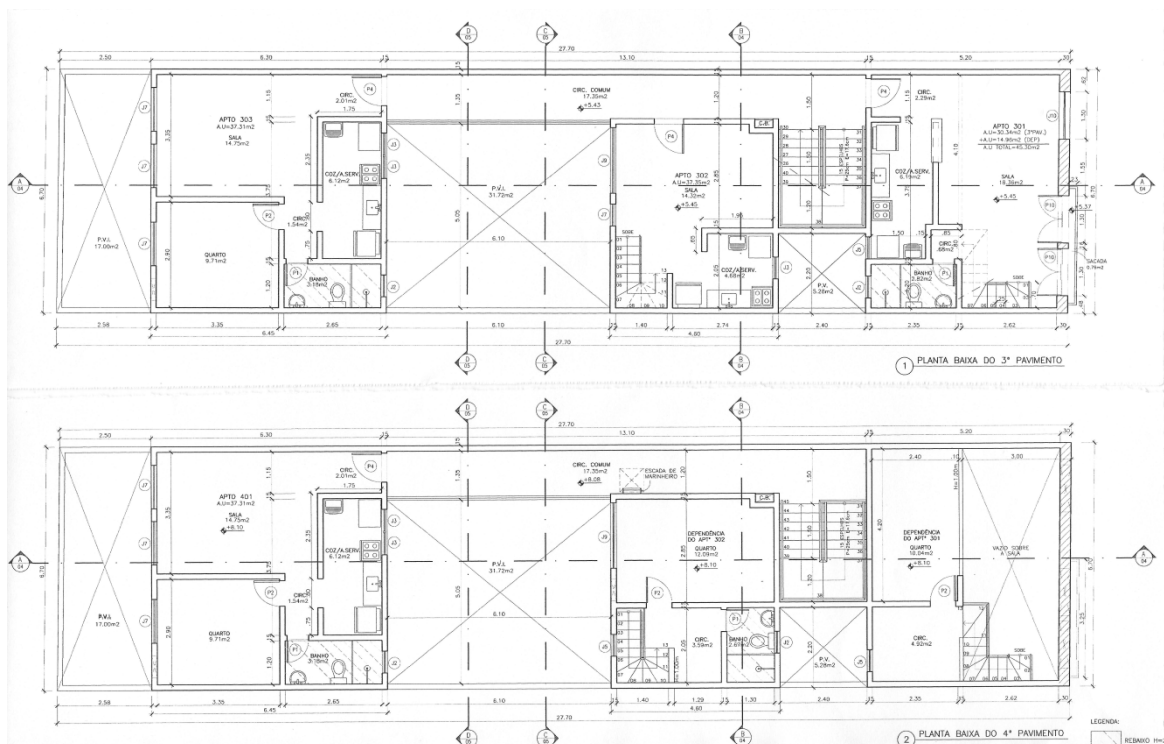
Planta baixa do 3º e 4º pavimento do empreendimento João Álvares 18.
